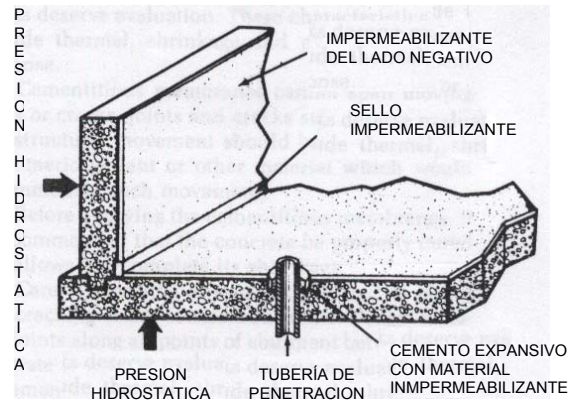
Vista Esquemática por debajo del suelo, lado negativo, impermeabilizante de membrana cementante mostrando penetración. Fuente: ACI 515-1R-79 (85).
